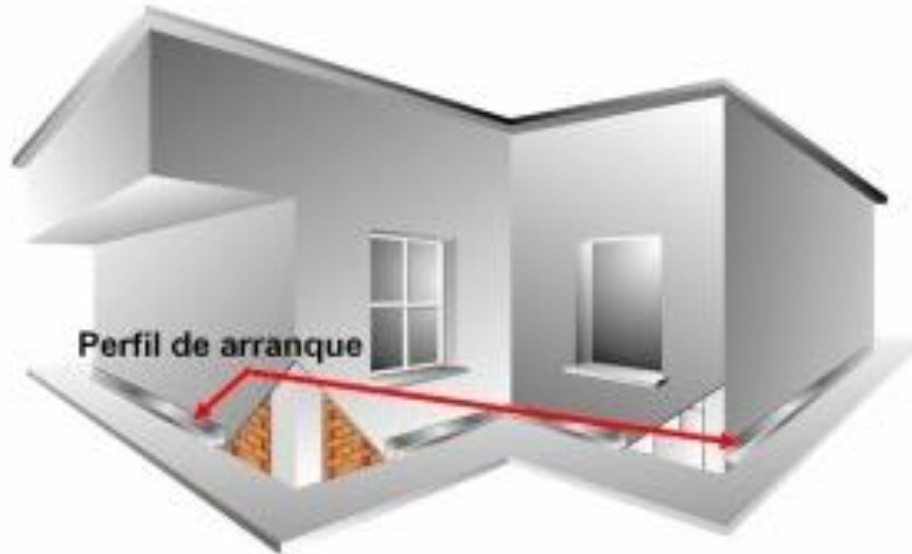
Detalle de la colocación del perfil de arranque sobre la fachada. Fuente: ChovA, Impermeabilización y aislamiento - SATE <https://chova.com/sistemas/aislamiento-termico-xps/aislamiento-paredes/sate/>.
